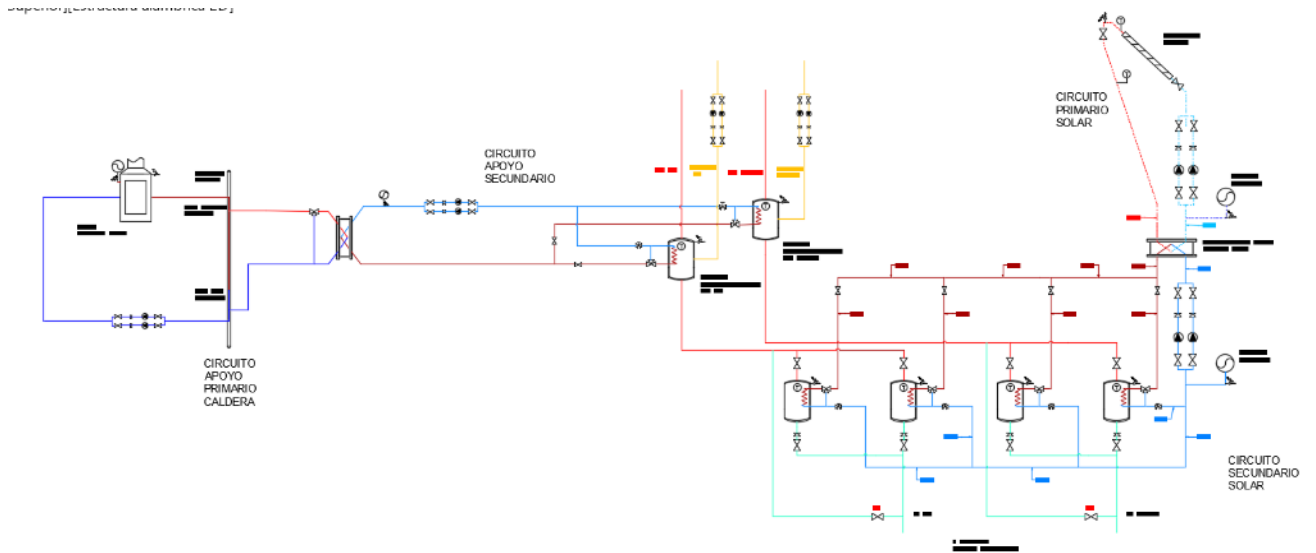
Sistema centralizado ACS solar y apoyo. Planos del proyecto
